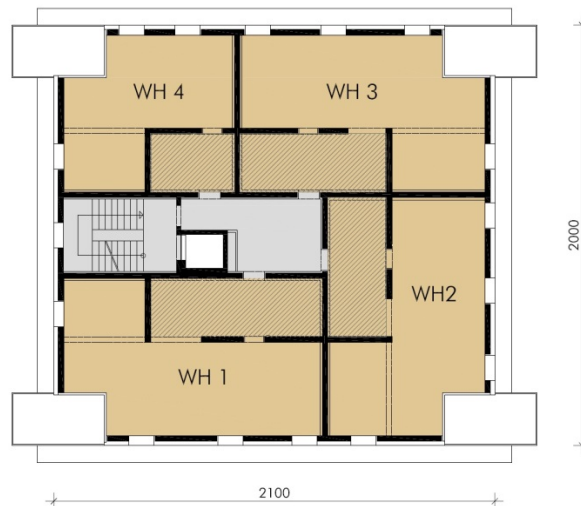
Basisgrundriss Regelgeschoss – Projektstudie Holzwohnbau in Graz<sup>10</sup>
